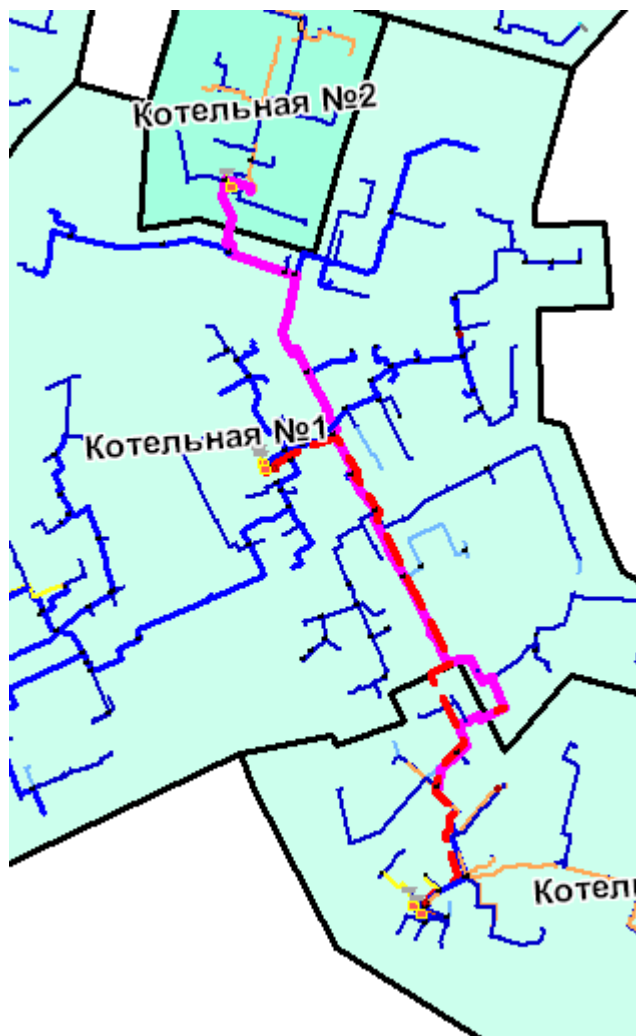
Схема прокладки трубопровода между котельными №14 и №1, и перекладки теплотрассы между котельными №1 и №2
